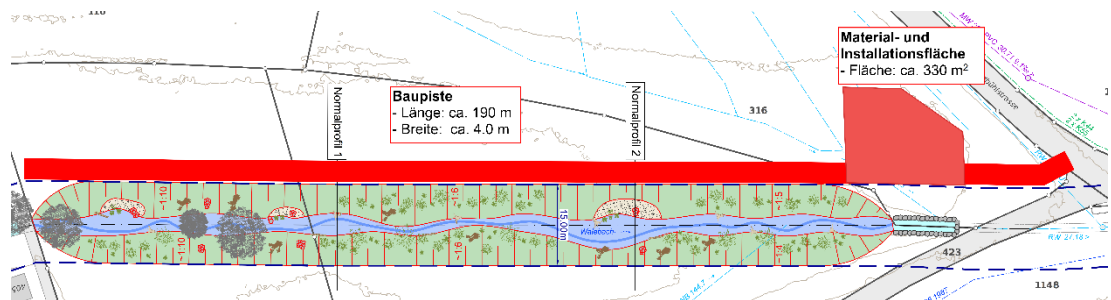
Vorgeschlagene Installationsfläche und Baupiste
